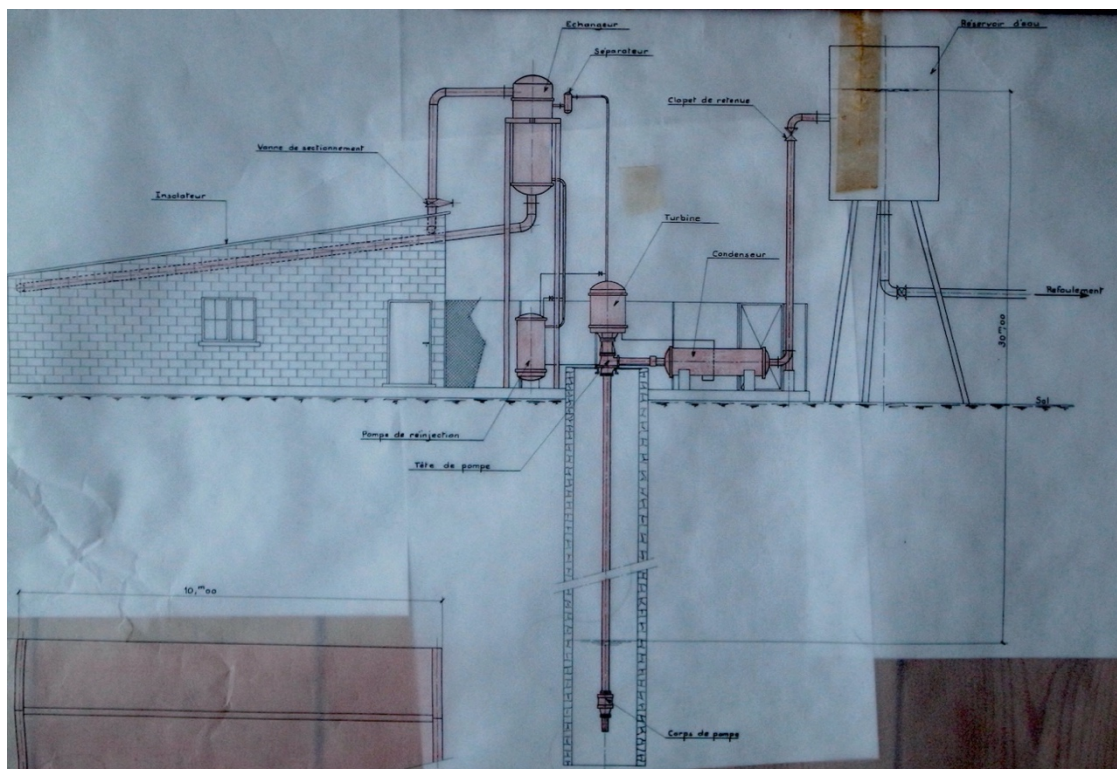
une version d'ITTEC sur puits. Nous constatons que les capteurs abritent un bâtiment. Plan 21437, 15 avril 1965, archives privées fonds usine Mengin.
